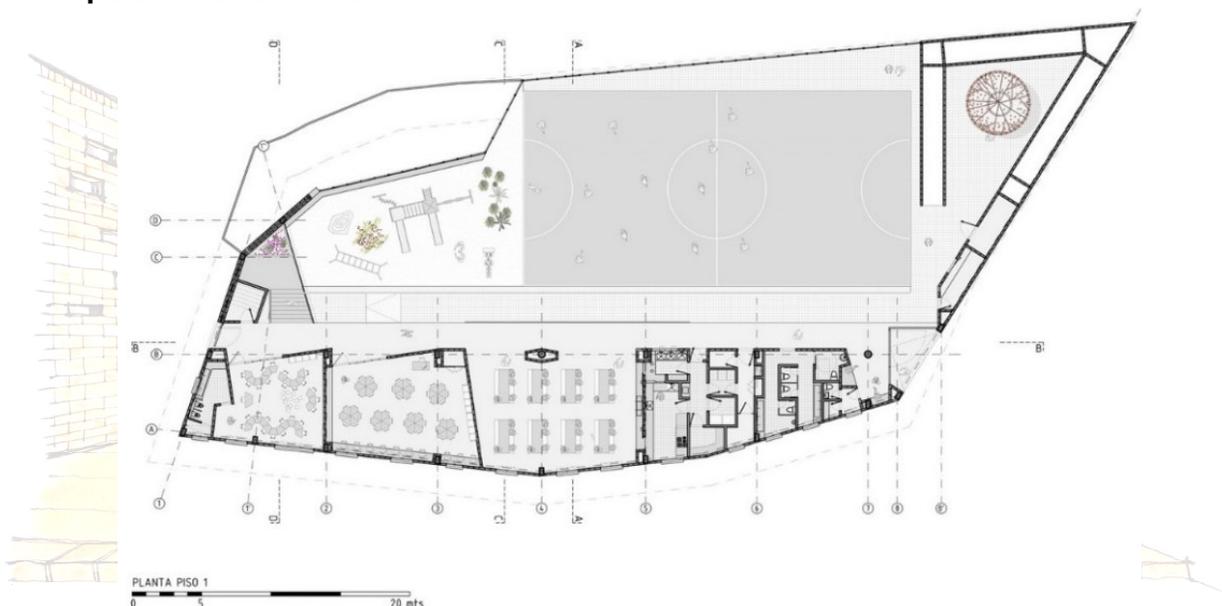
/ Institución Rural Chaparral/ Planta baja/ Año 2015/ Obtenido de PlanB Arquitectos
